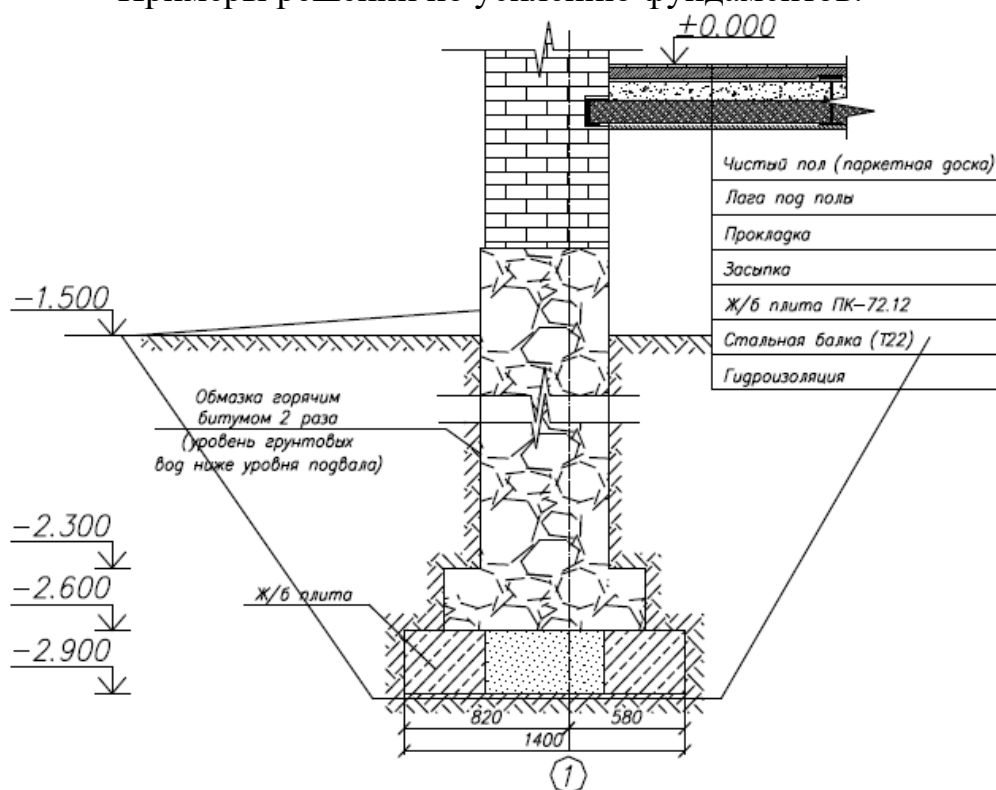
Усиление фундамента под наружную стену с использованием железобетонных вставок и защита стены фундамента обмазочной гидроизоляцией
